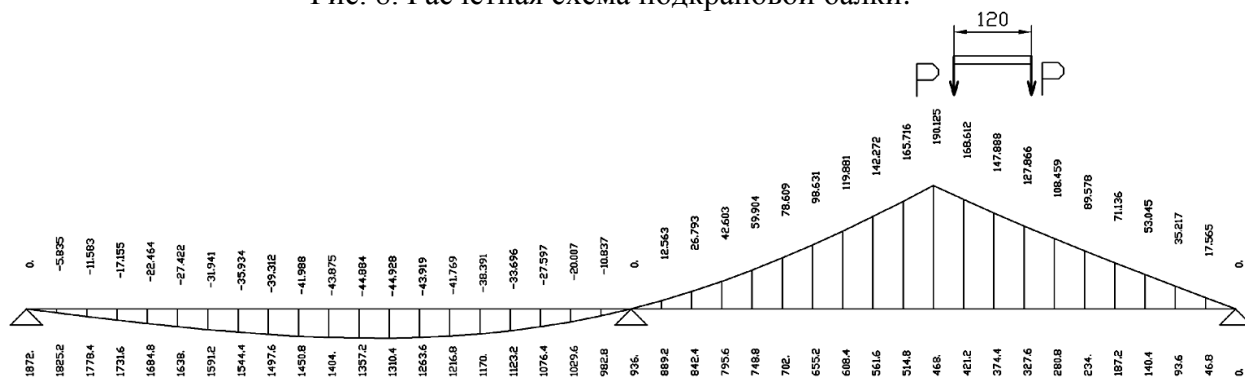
Линия влияния изгибающего момента при расчете подкрановой балки.
